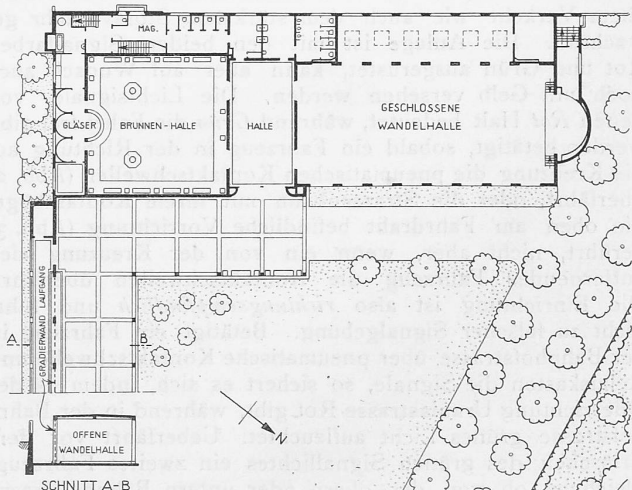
Grundriss des südwestlichen Teils. — Masstab 1:700.
